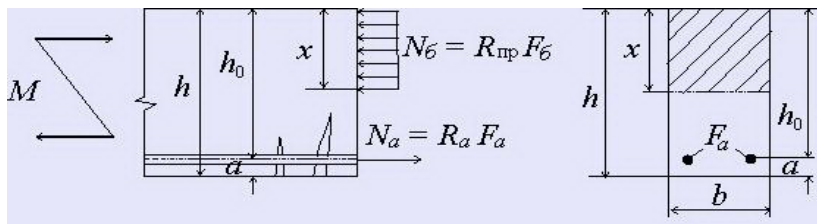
Расчетная схема изгибаемой железобетонной балки
